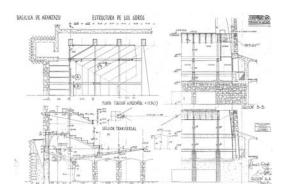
Plano nº 85 del Proyecto de ejecución: Plano de estructura de los coros. (Archivo del Santuario de Arantzazu)
